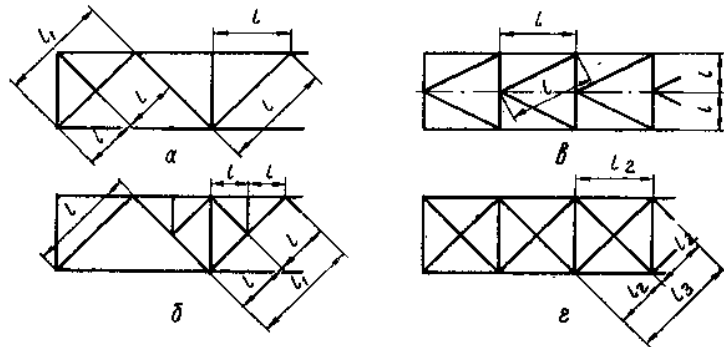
Схемы ферм для определения расчетных длин элементов: а, б — треугольная решетка соответственно со стойками и шпренгелем; в — полураскосная треугольная решетка; г — перекрестная решетка со стойками.
